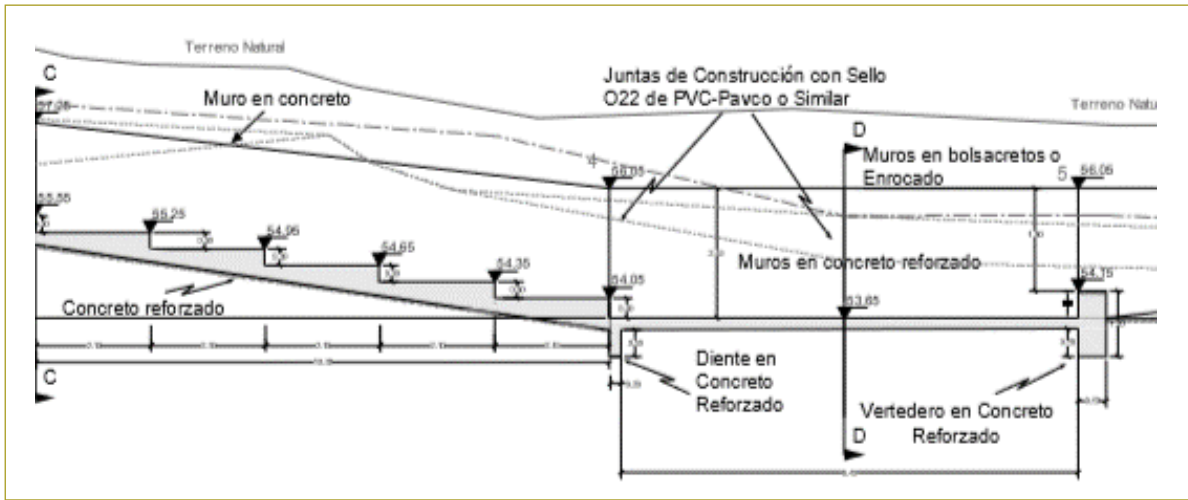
Perfil longitudinal de la estructura de disipación. Caño Piedras.
